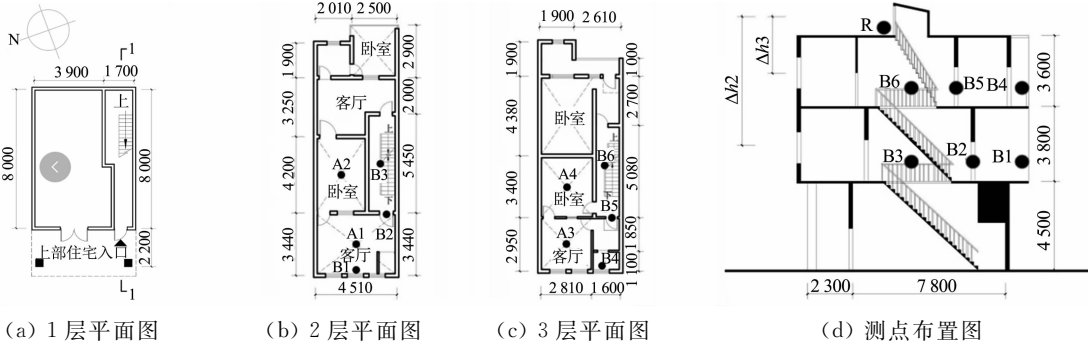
担水巷 3 号住宅平面图及测点布置图(单位:mm)
